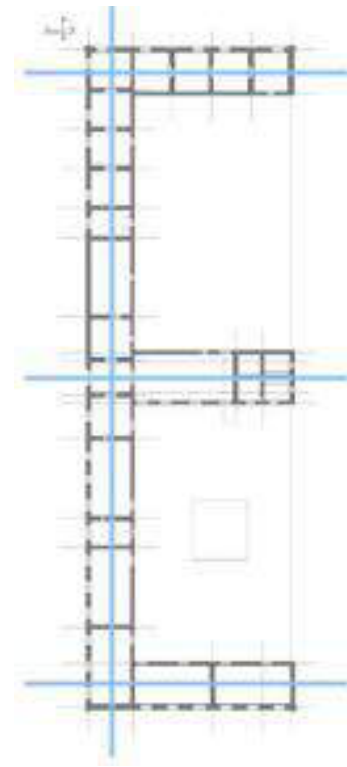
Planta del inmueble, ejes rectores y forma del partido en E
